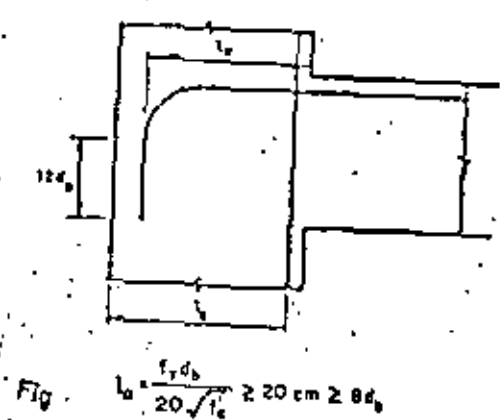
Anclaje de refuerzo longitudinal de vigas
